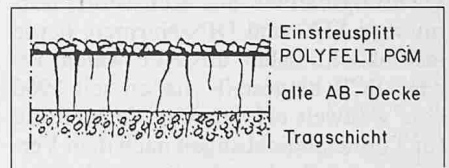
Einstreudecke bei der Asphaltstrassensanierung
